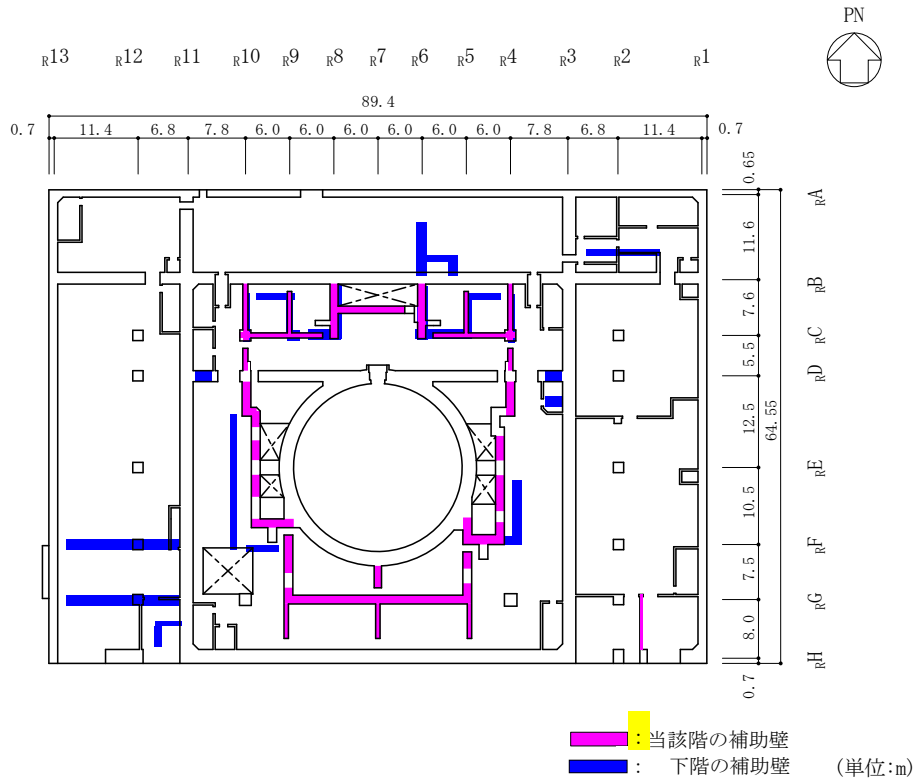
(3) 補助壁の配置図 (EL 23.8m)
